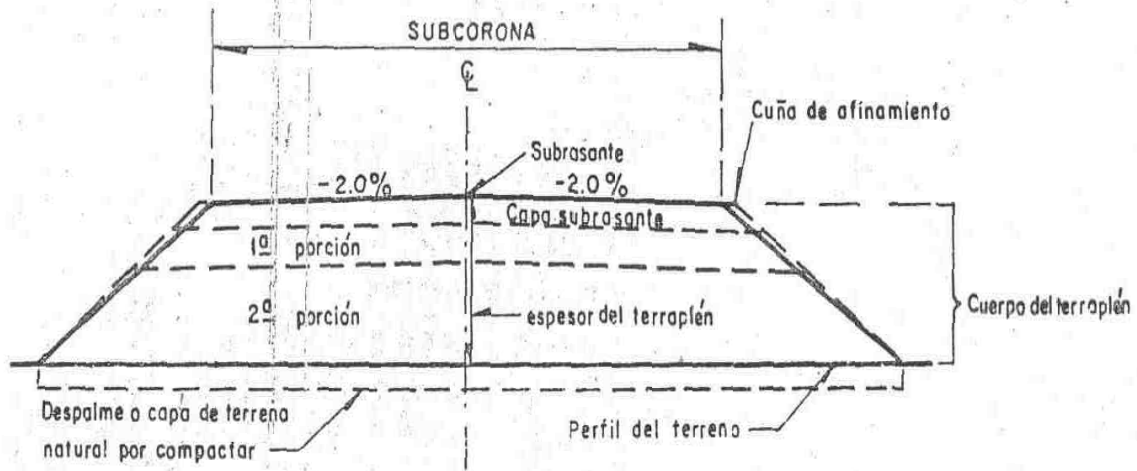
Sección de construcción de un terraplén en tangente.
